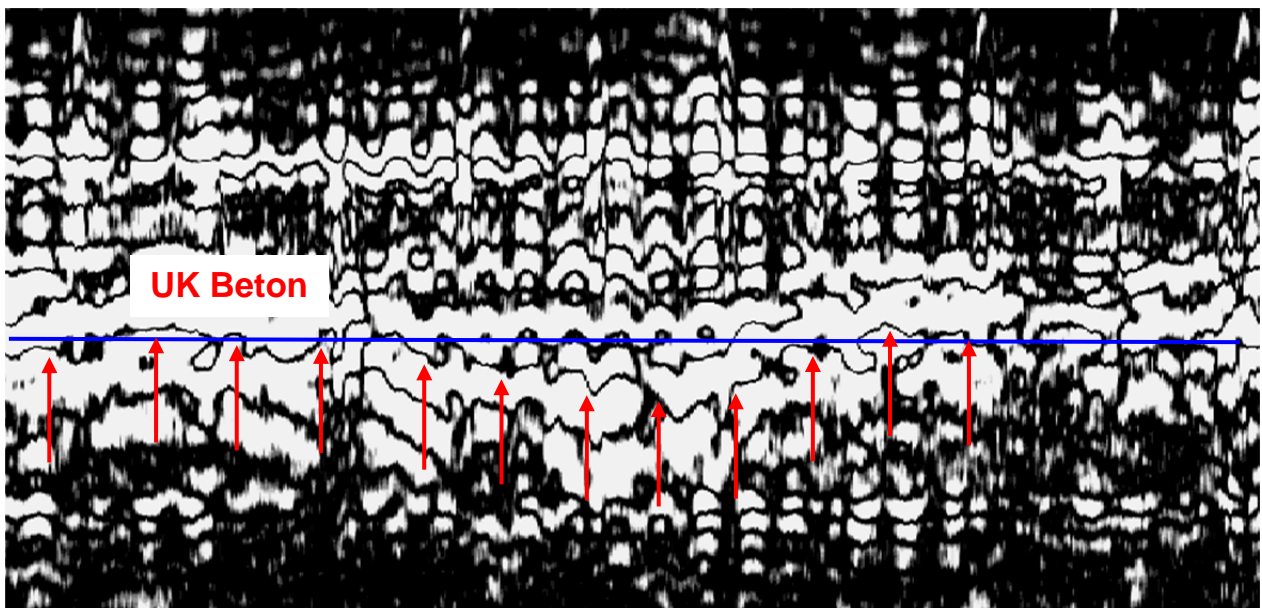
Radargrammbeispiel – Detektion Hohllage unter Betondecke
